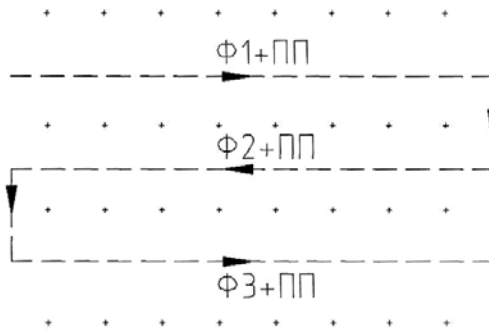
Організаційна схема монтажу ферм і плит покриття
